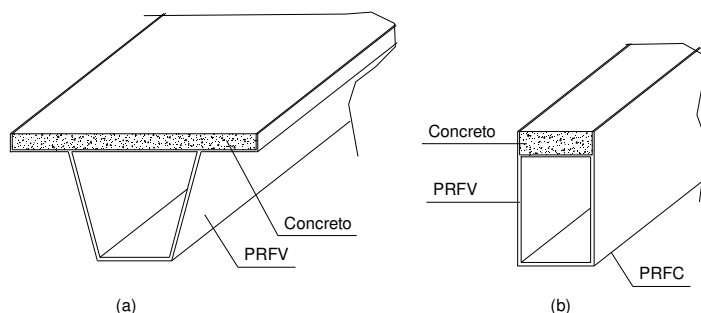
Placa da viga modular e seção transversal da viga. Fonte: LEE et al. (1995).
